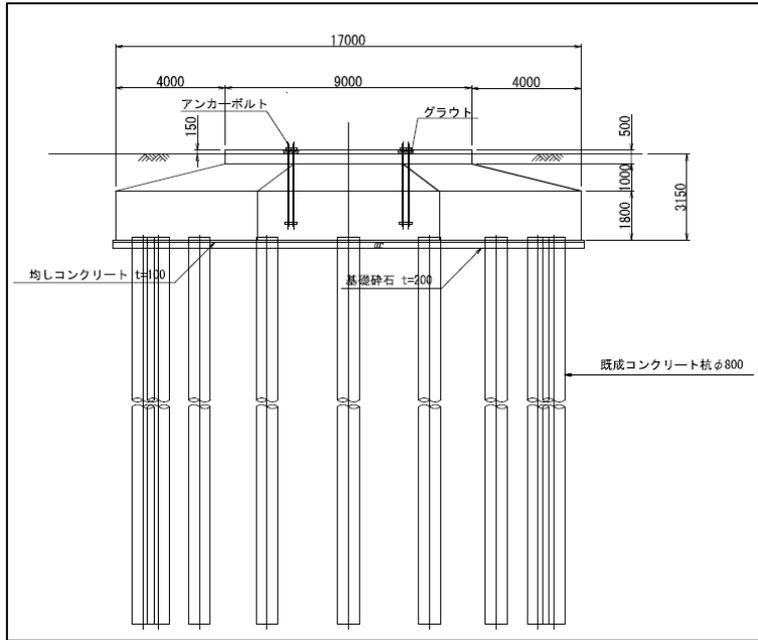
2. 7-1(1) 基礎構造概要図 (断面図)
